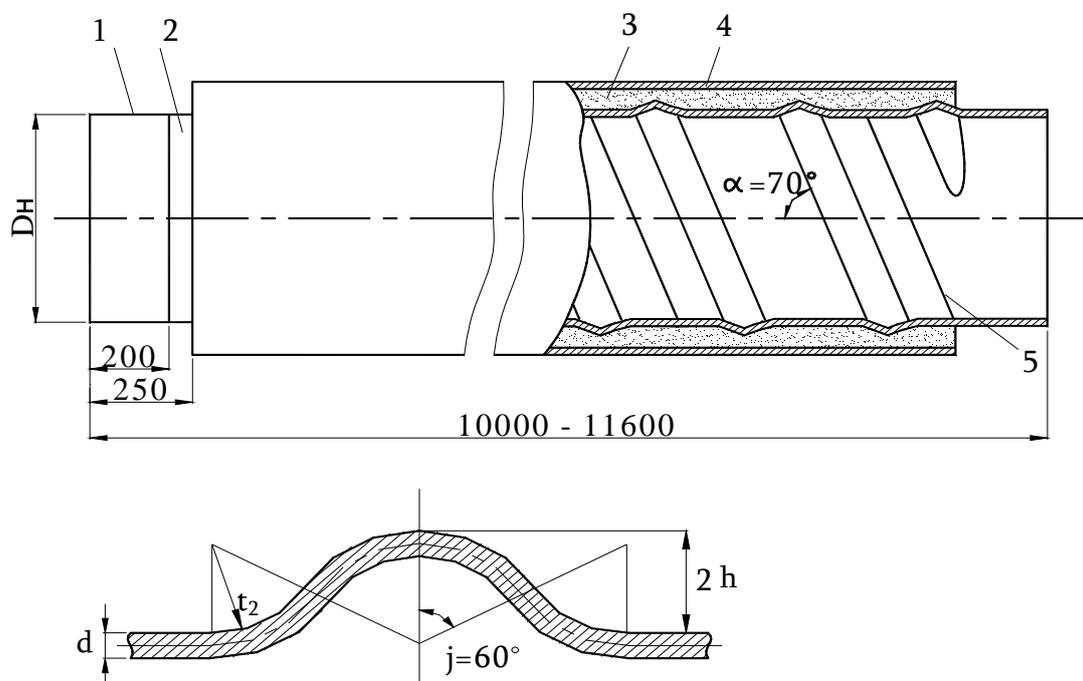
Самокомпенсирующаяся трубная секция: 1 – стальная труба; 2 – антикоррозионный слой; 3 – теплоизоляционный слой; 4 – слой механической защиты и гидроизоляции; 5 – винтовой сварной шов
